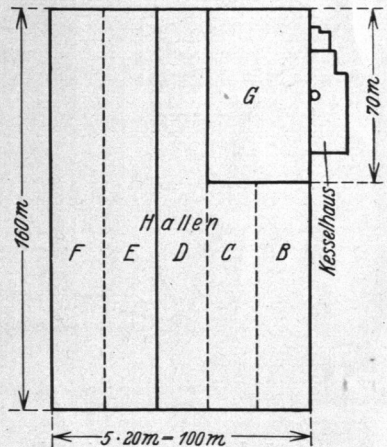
Grundrißskizze eines umgebauten Hallenblockes.
